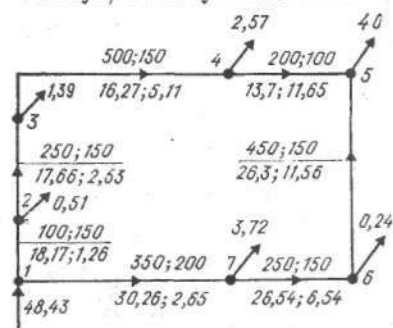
Расчетная схема наружной водопроводной сети при пожаре
